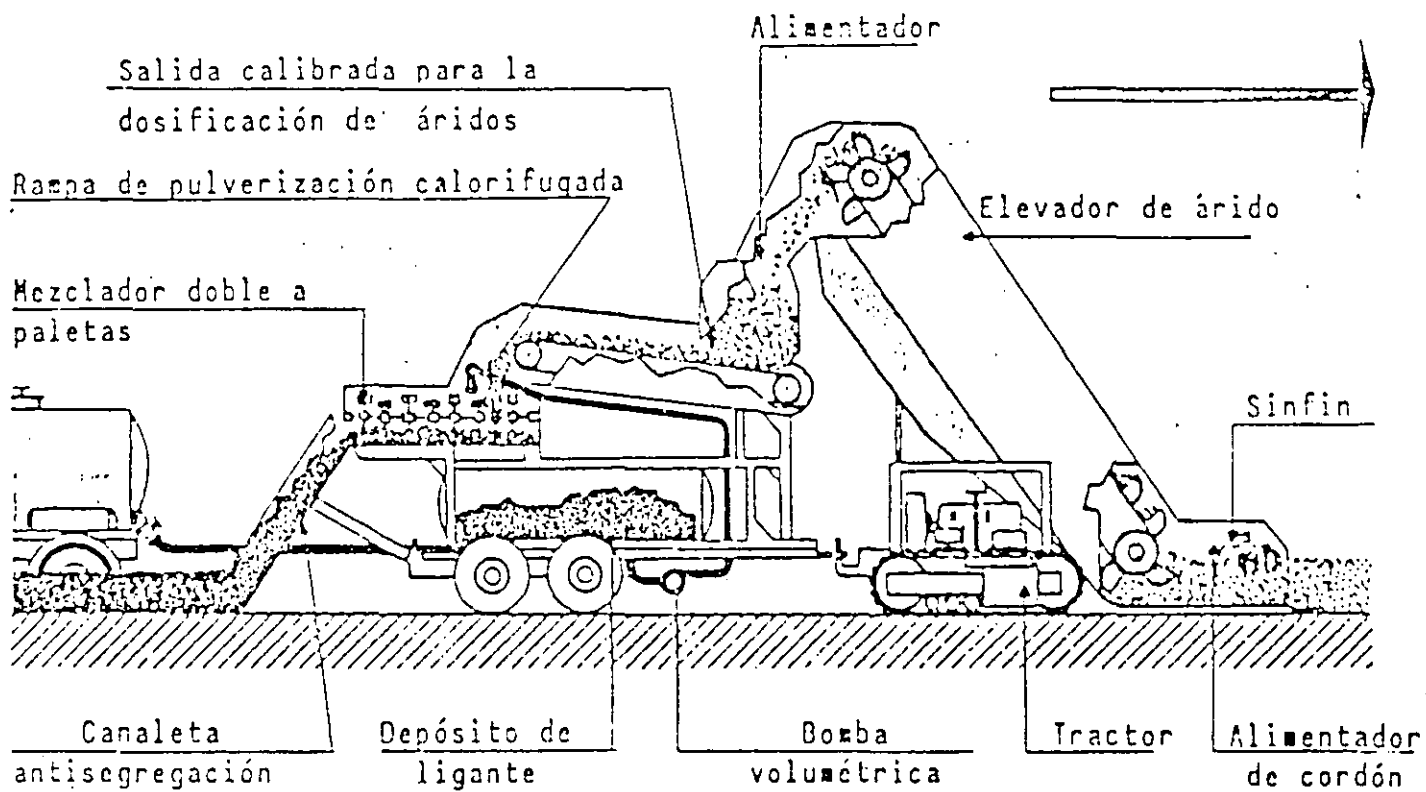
Esquema de una planta de fabricación de M. A. F.
